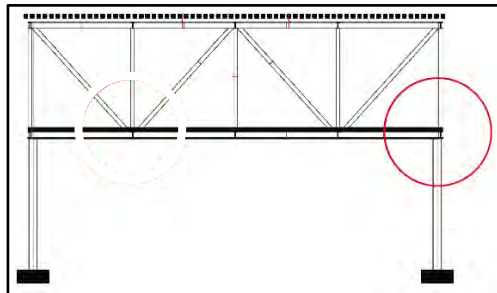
Detalle Estructural - Anclaje malla espacial a viga
